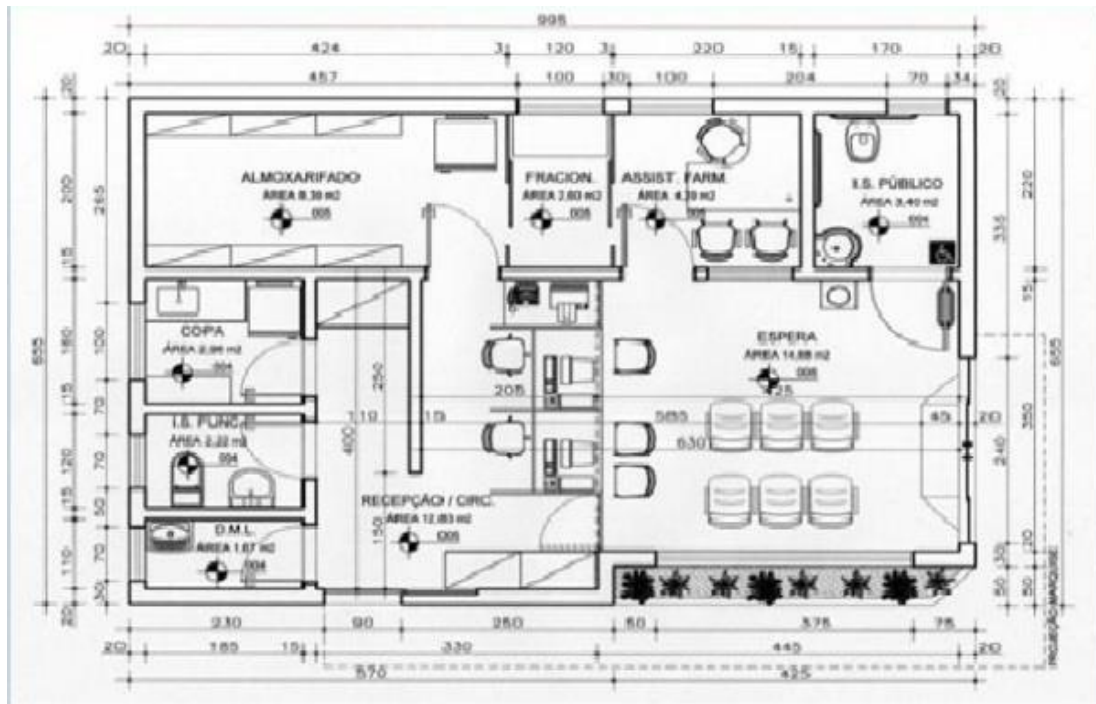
Planta Padrão Rede Farmácia de Minas.
